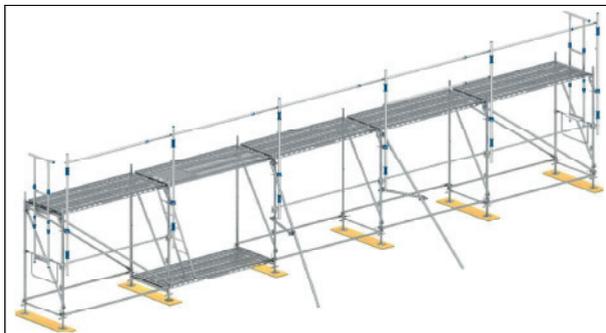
Vorübergehende Kippsicherung der 1. Gerüstlage mit Gerüstrohren
